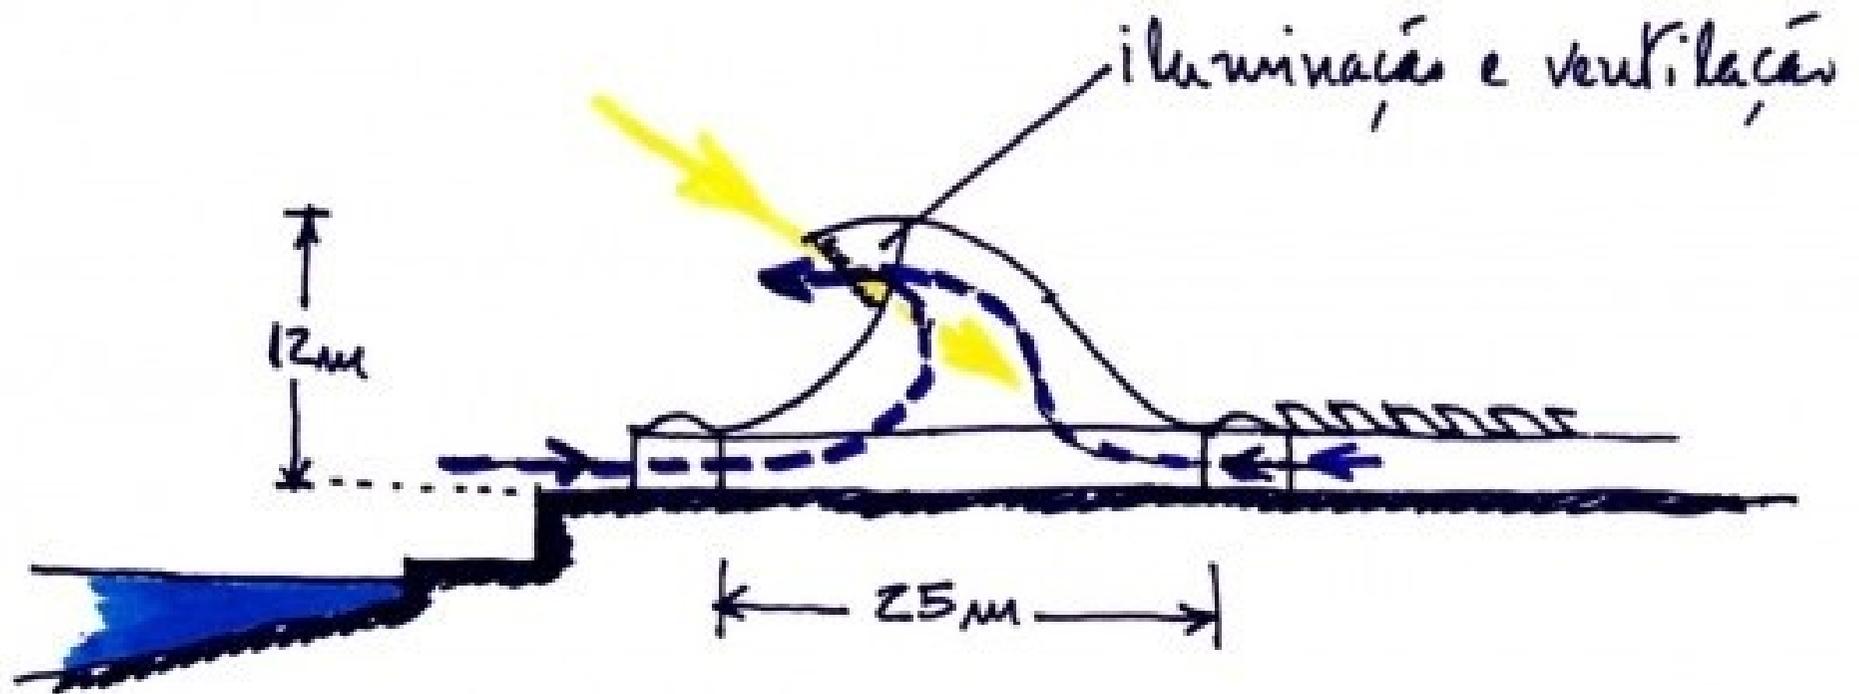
SARAHA Lago Norte – Brasília – Corte esquemático do sistema de ventilação.
